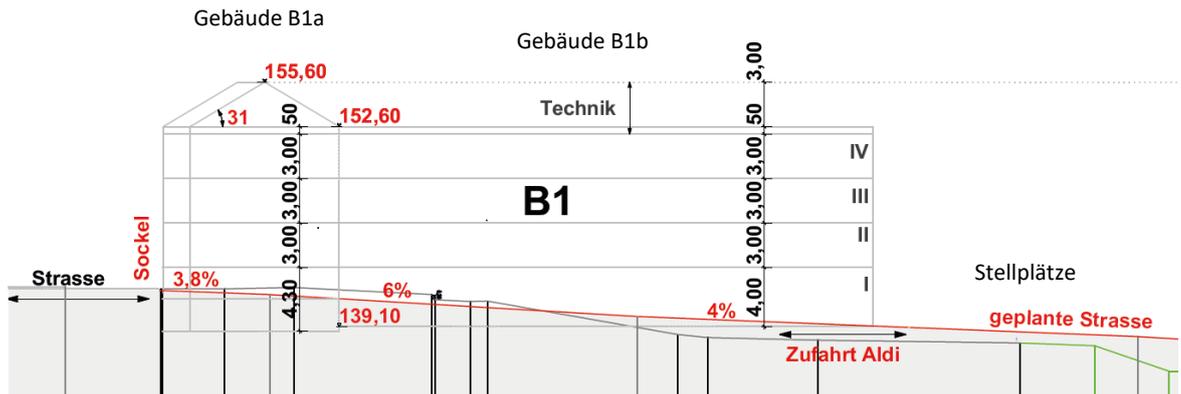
Schnitt durch Gebäude B1a (links) und Gebäude B1b (rechts)
